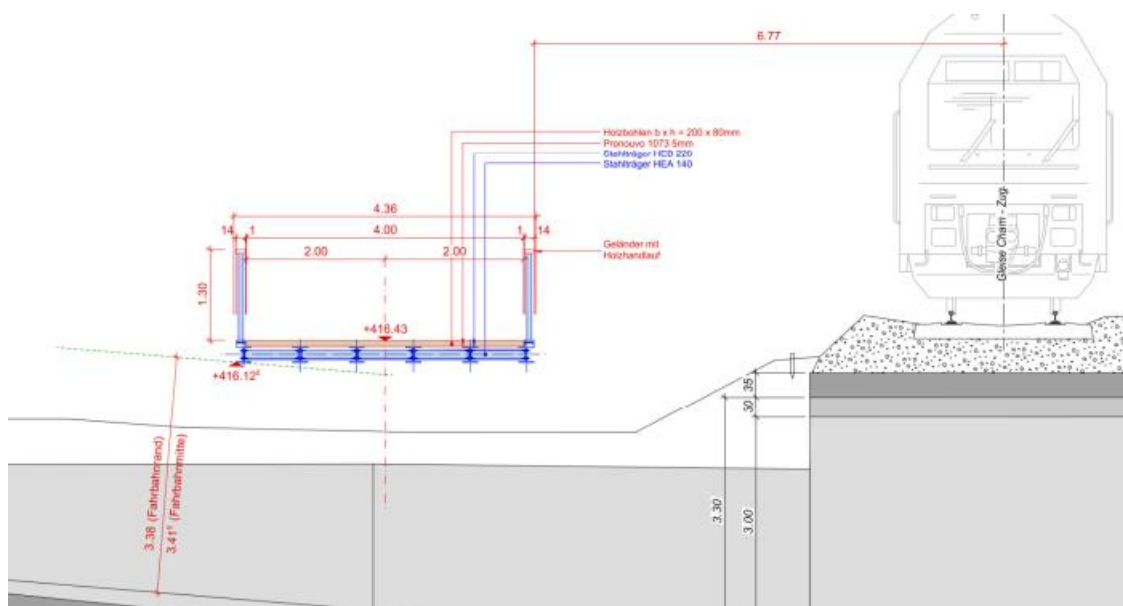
Querschnitt Radwegbrücke Brüggli West, Stand Bauprojekt (August 2024)
